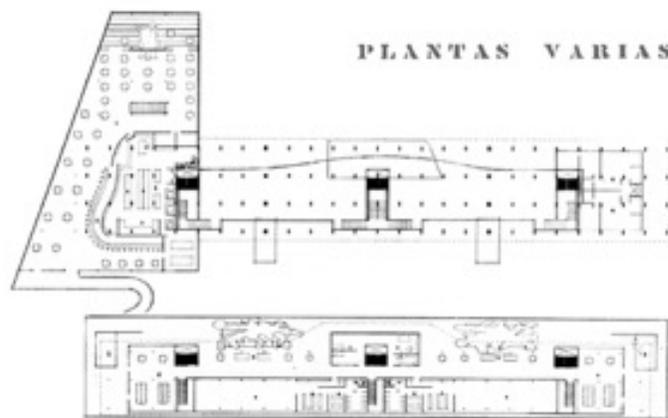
Plantas varias (planta mezanine y roofgarden) del edificio de apartamentos desarrollado.
